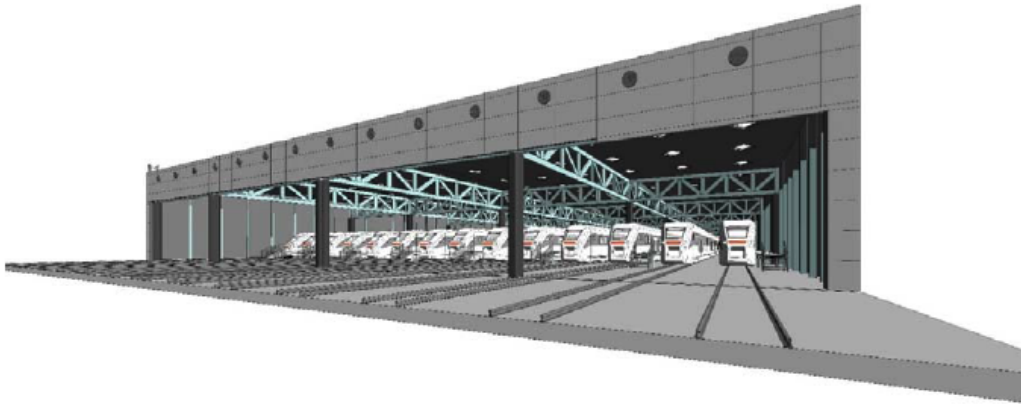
Vista de distribución y fachadas de cocheras.
